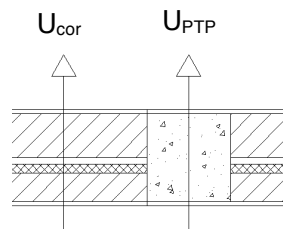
Zona de parede corrente e zona de ponte térmica plana (pilar)
